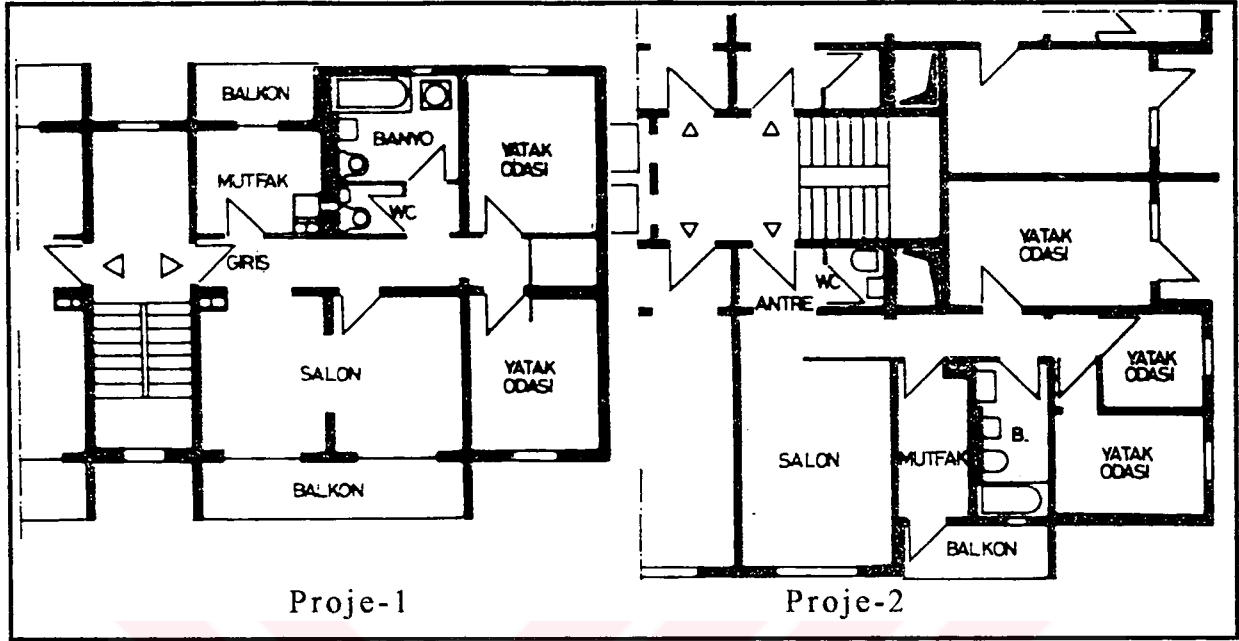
Prefabrike İskelet Sistemle Örnek Kat Planı Tasarımı
